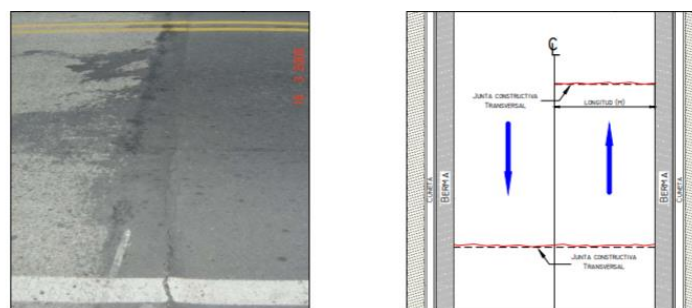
Fisura transversal en junta de construcción (FCT, Unidad de medida: m).
